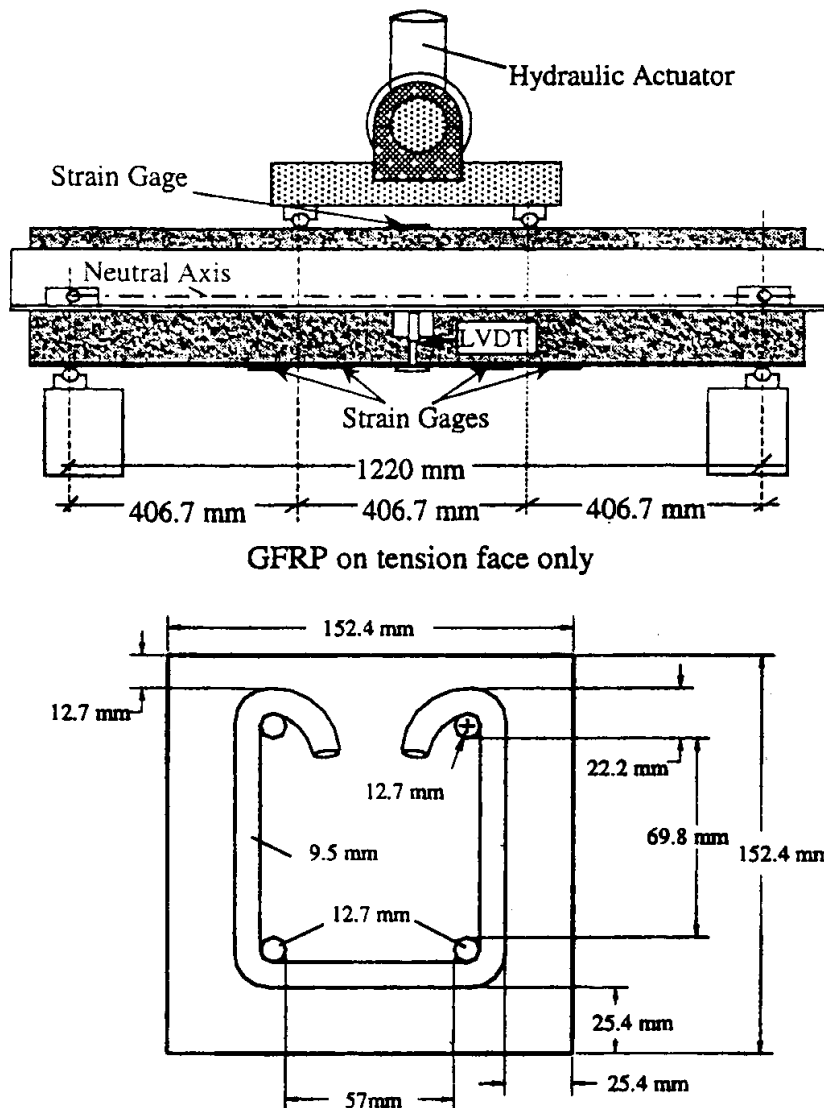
Dimensions des éprouvettes (d'après [59])
